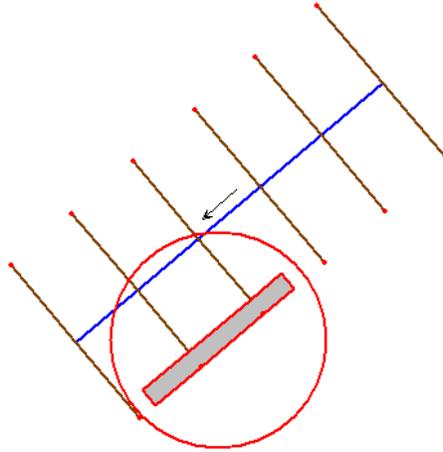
Secciones Transversales del Canal y la Estructural Lateral por donde se va romper el Canal
